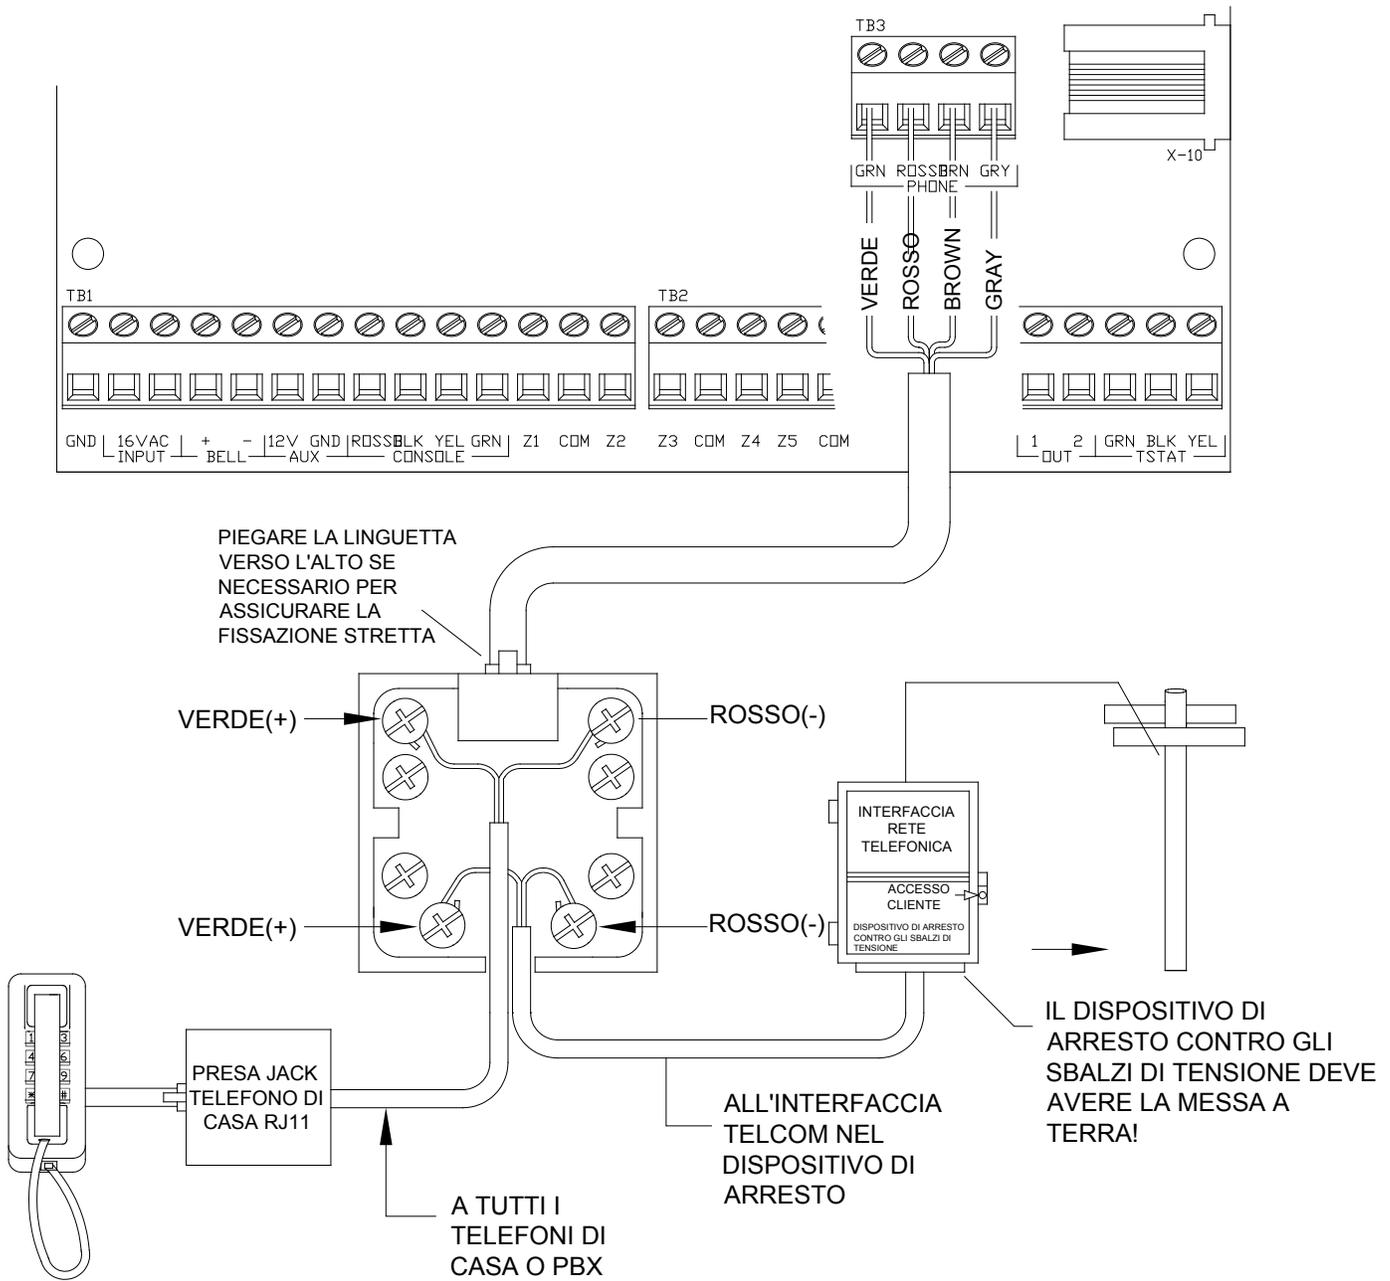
COLLEGAMENTI DELLA PRESA JACK RJ31X
